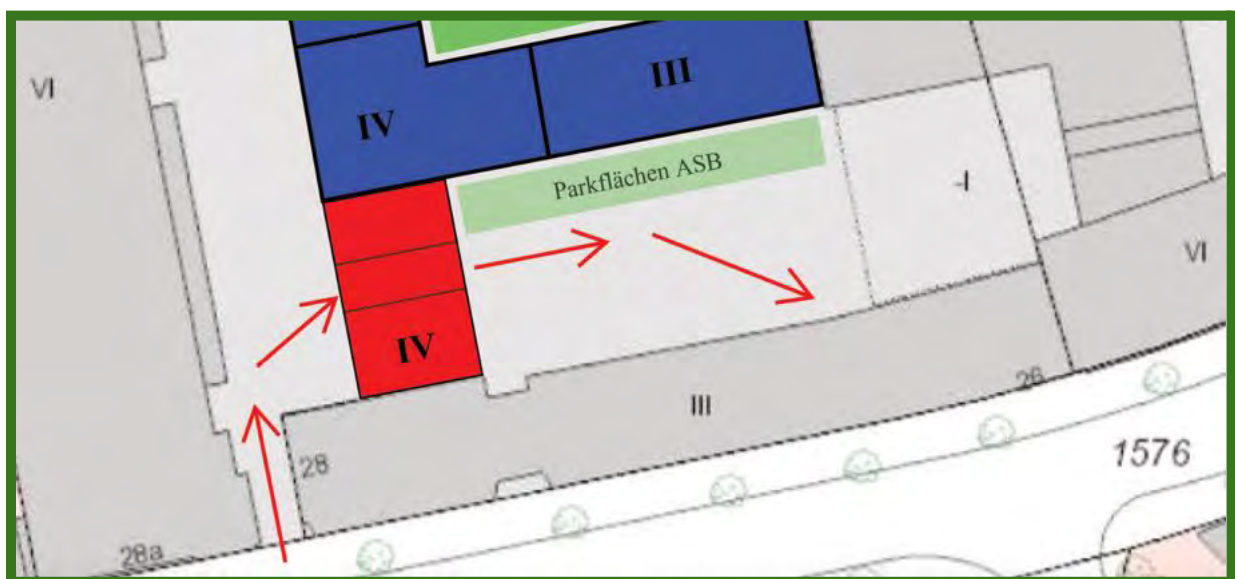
LKW-Zufahrt Sanitätshaus MPM an der Behringstraße 26 / Parkflächen ASB
